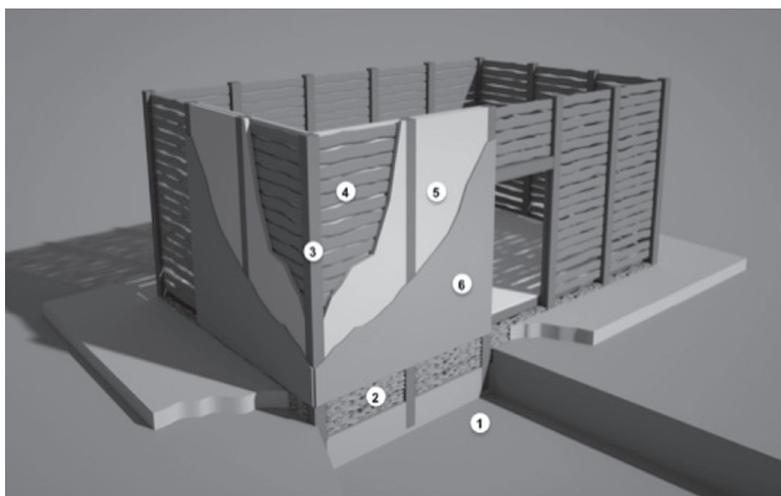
Modelo descriptivo preliminar del sistema madera-tierra en base a postes empotrados. 1- Terreno natural. 2- Basamento de piedra laja y tierra. 3- Postes empotrados de roble. 4- piezas rústicas entrabadas de roble. 5- Primera carga-relleno de tierra. 6- Revoque de tierra.
